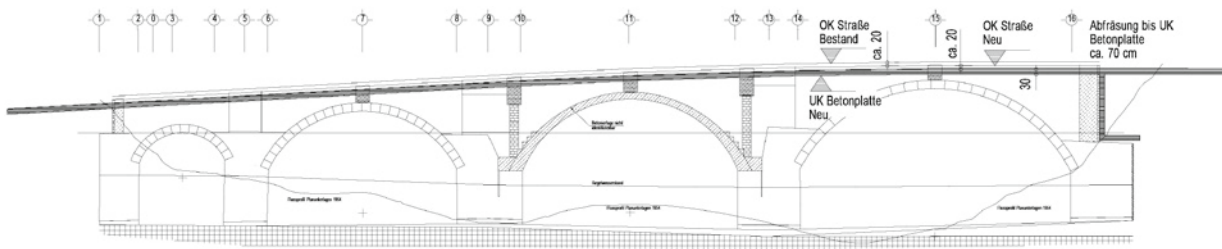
Skizze der Gesamtbrücke mit einem Überbau aus Stahlbeton
